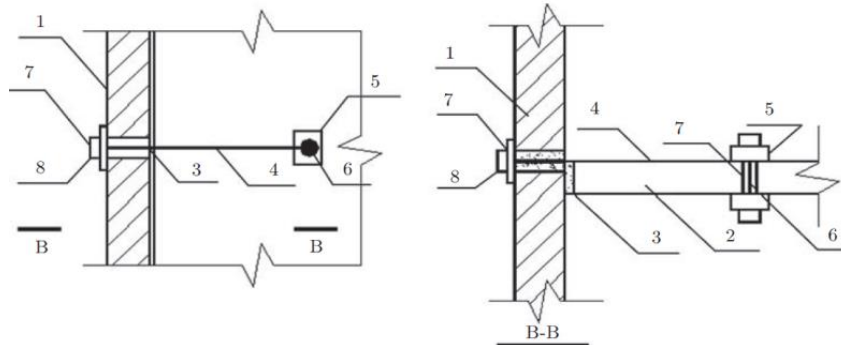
Perkuatan kolom beton bertulang pada sudut bangunan (*Retrofitting of building structures*, Xilin Lu (editor), 2010)
